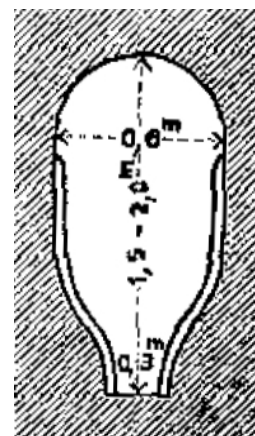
Sezione dell'acquedotto (da BASSEL, 1883).
